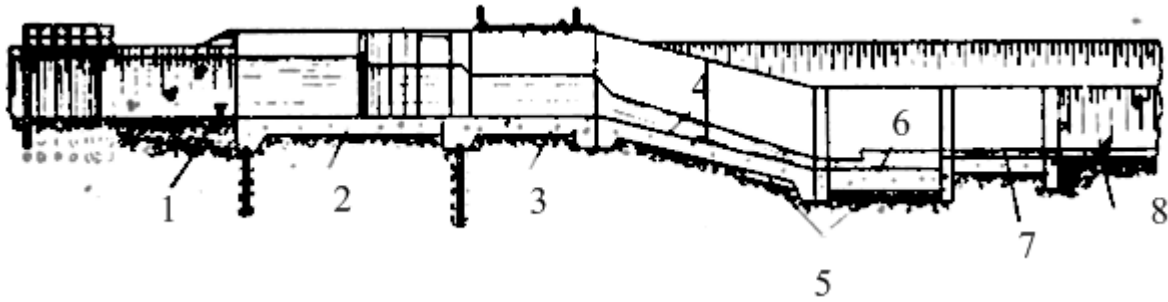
Бетонний водоспуск з швидкотоком:
